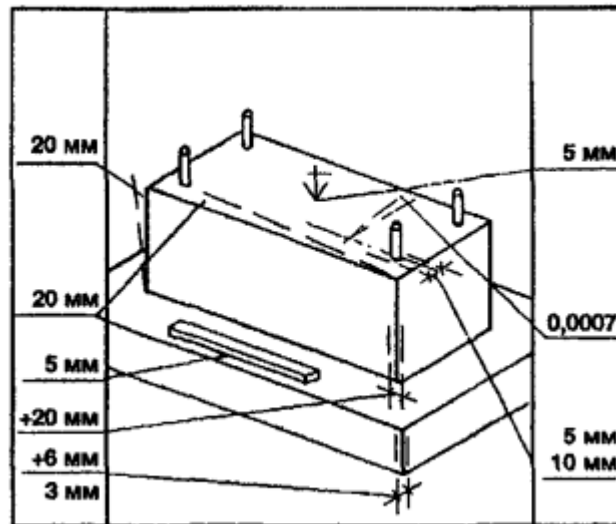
Допускаемые отклонения при приемке монолитного фундамента
